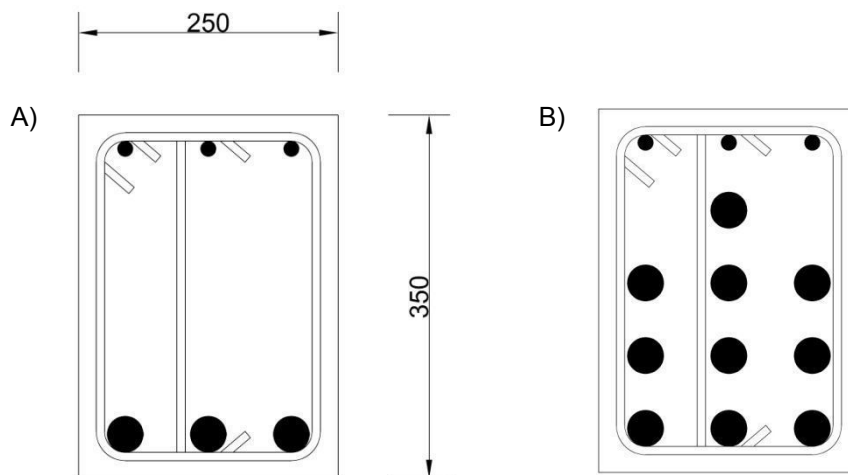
De izquierda a derecha: A) detalle para los apoyos; B) detalle para el centro de la lámina. Cotas en milímetros.
